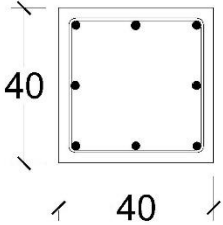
Penulangan Balok Lantai 6 Sampai 10
